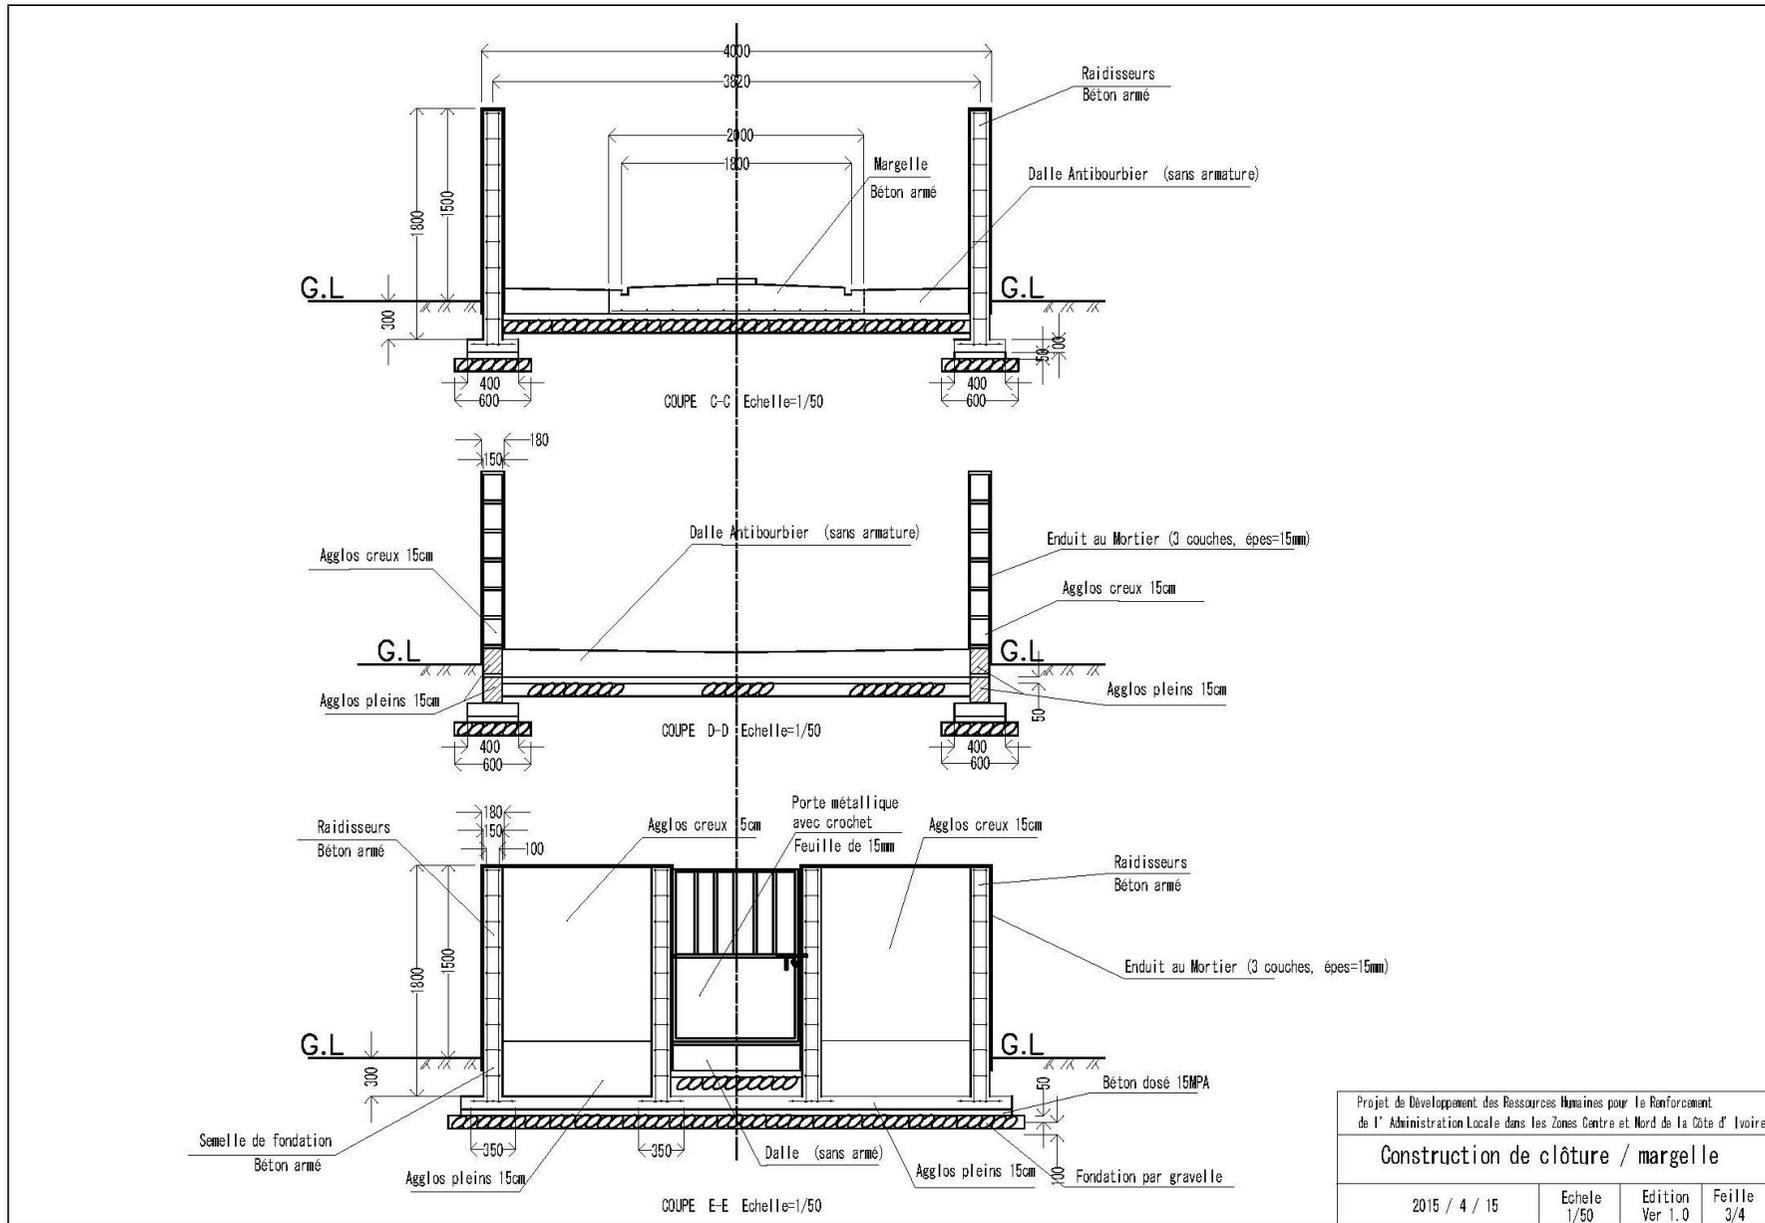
Plan de la superstructure d'une PMH (2/4)
